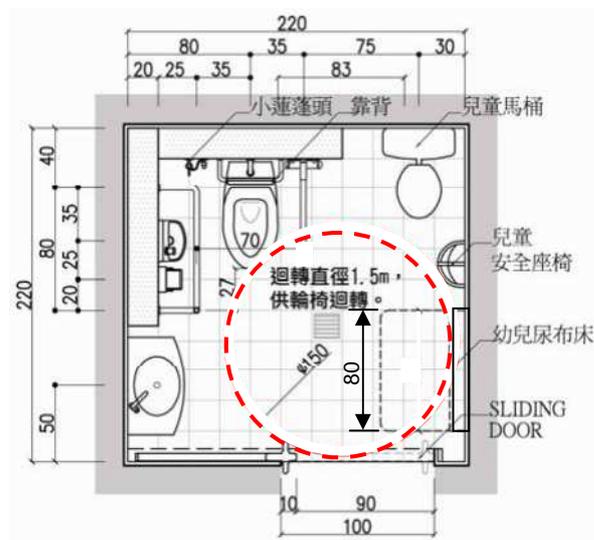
親子廁所設計平面圖 (單位：cm)
